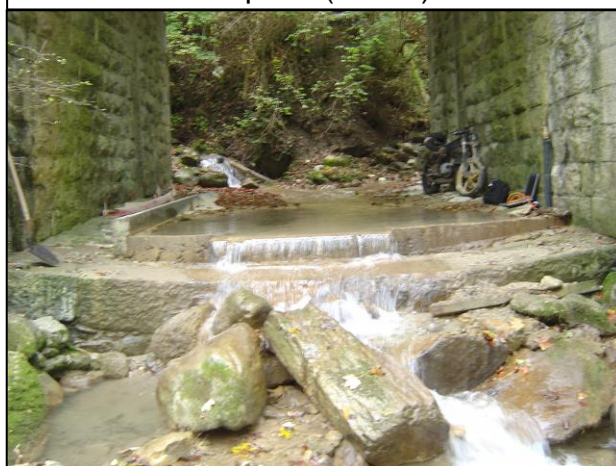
Seuil jaugeur du ruisseau des Moises (Drailant)
